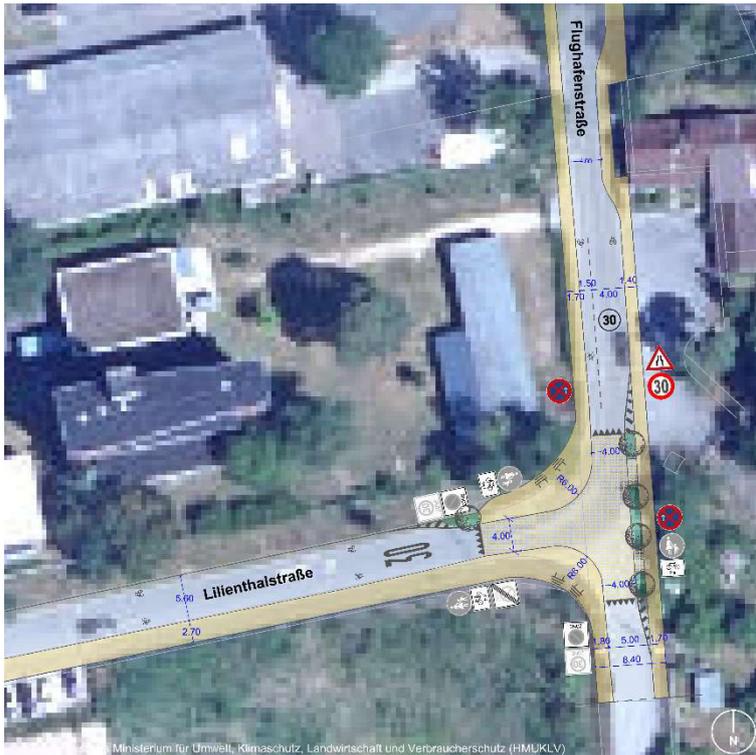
Flughafenstraße/Lilienthalstraße: Detail Gestaltung Zoneingang
